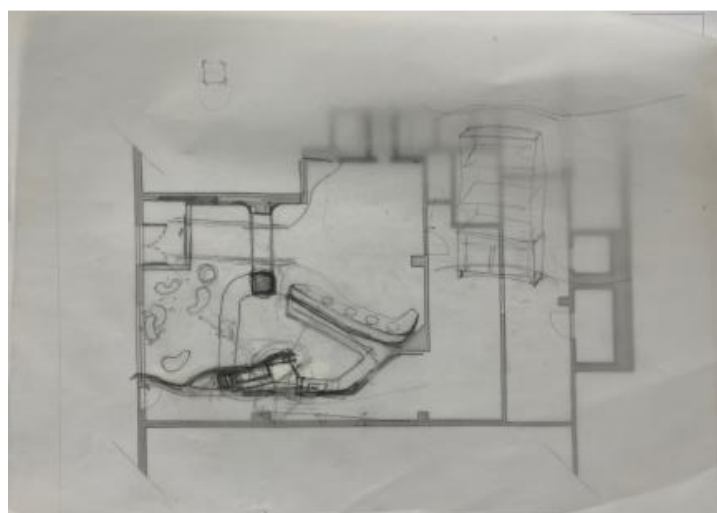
Planta de estudo 9. Fonte: Autora, 2025
